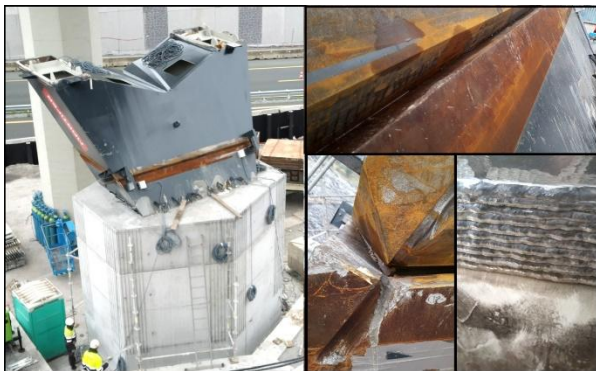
Montaje de dovela 2. Espesores de chapa y uniones soldadas
